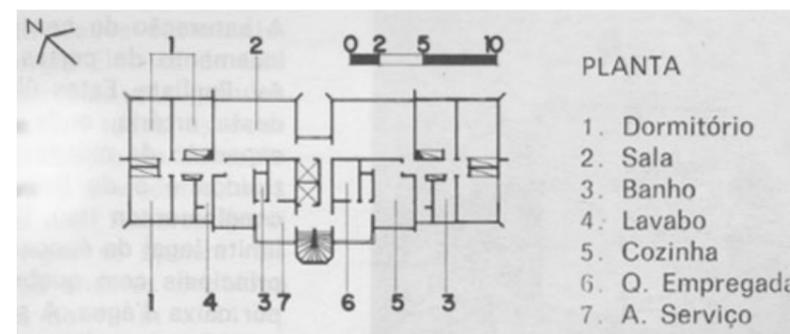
Planta do pavimento tipo edifício Rossi-Leste. Fonte: XAVIER, LEMOS e CORONA, 1983, p. 71.
